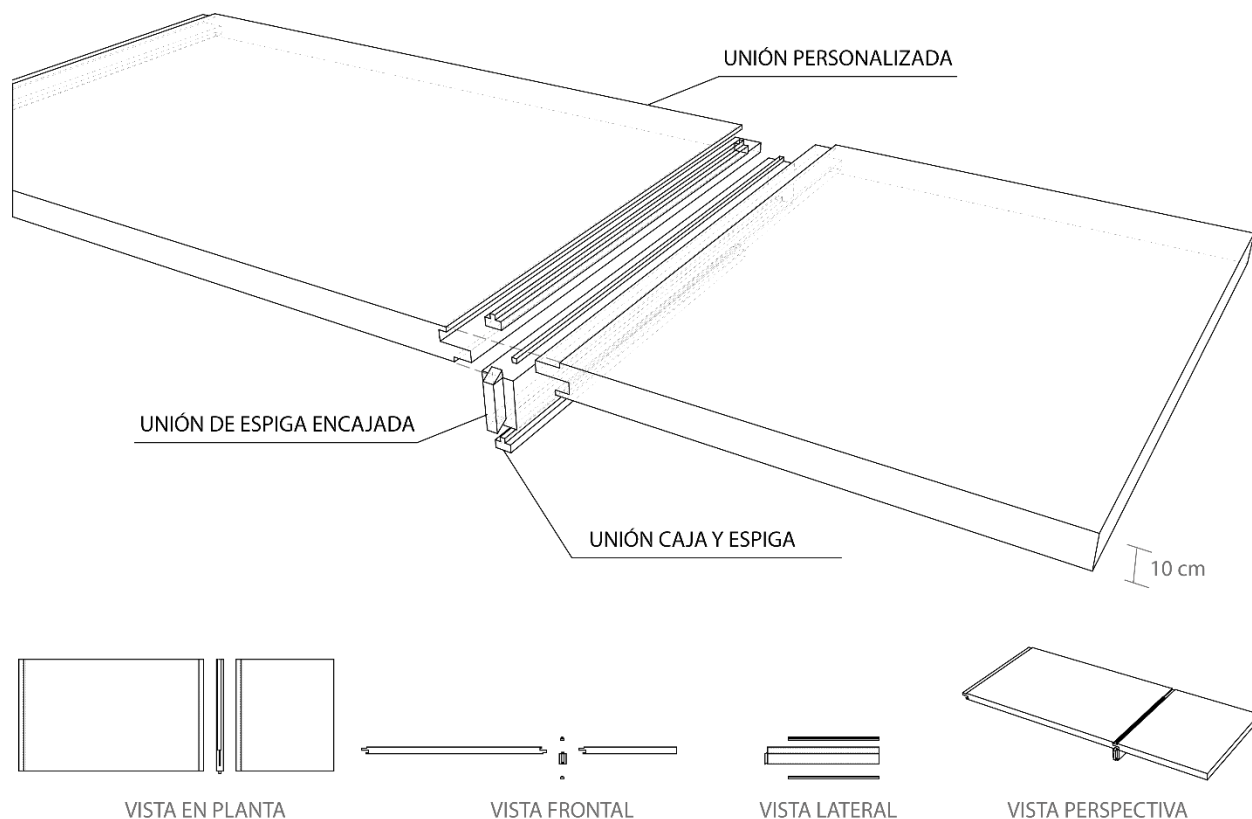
Diseño preliminar unión losa CLT con viga estructura primaria, para intersecciones interiores.
